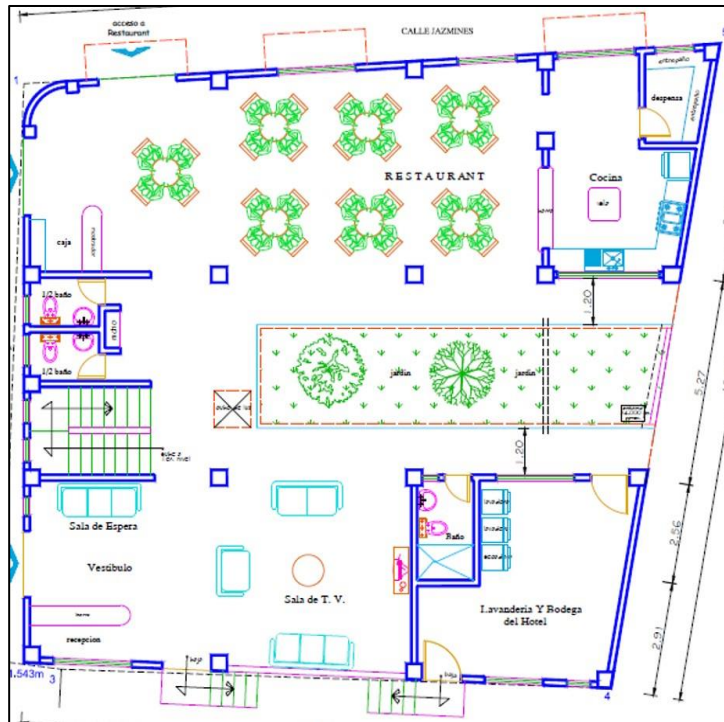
Planta arquitectónica de la planta baja del proyecto.
